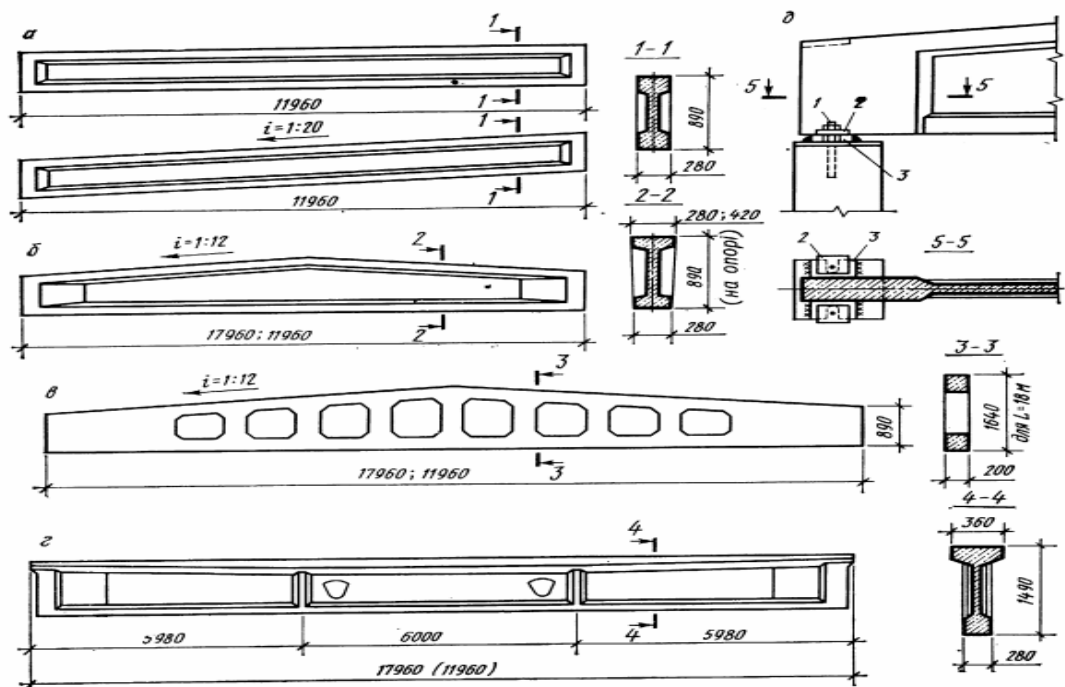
Залізобетонні балки покриття: а, г – односхилі й плоскі двотаврового перерізу; б – те саме, для багатосхилих покриттів; в – решітчаста для багатосхилих покриттів; д – вузол опирання на колону; 1 – анкерний болт; 2 – шайба; 3 – опорна плита
